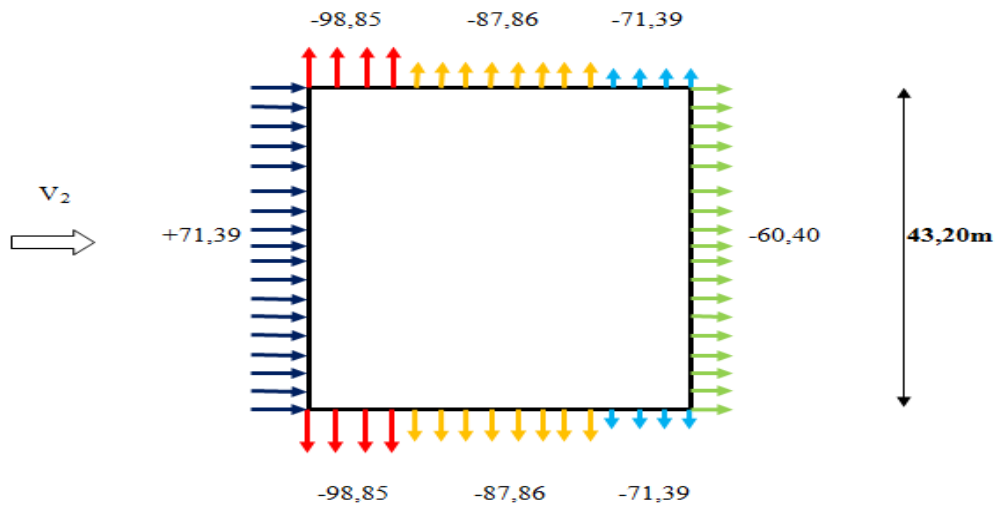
Pressions sur les parois verticales suivant pignon (RDC-Niveau 1)
